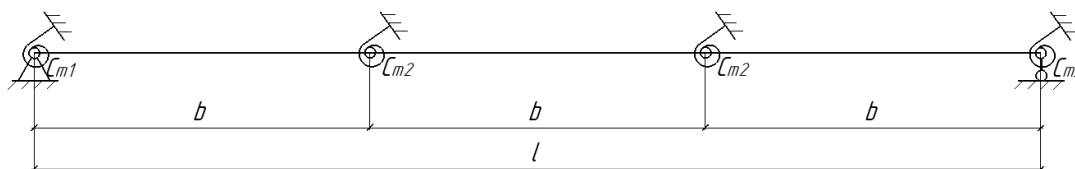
РС нижнего пояса – балка на угловых упругих опорах
